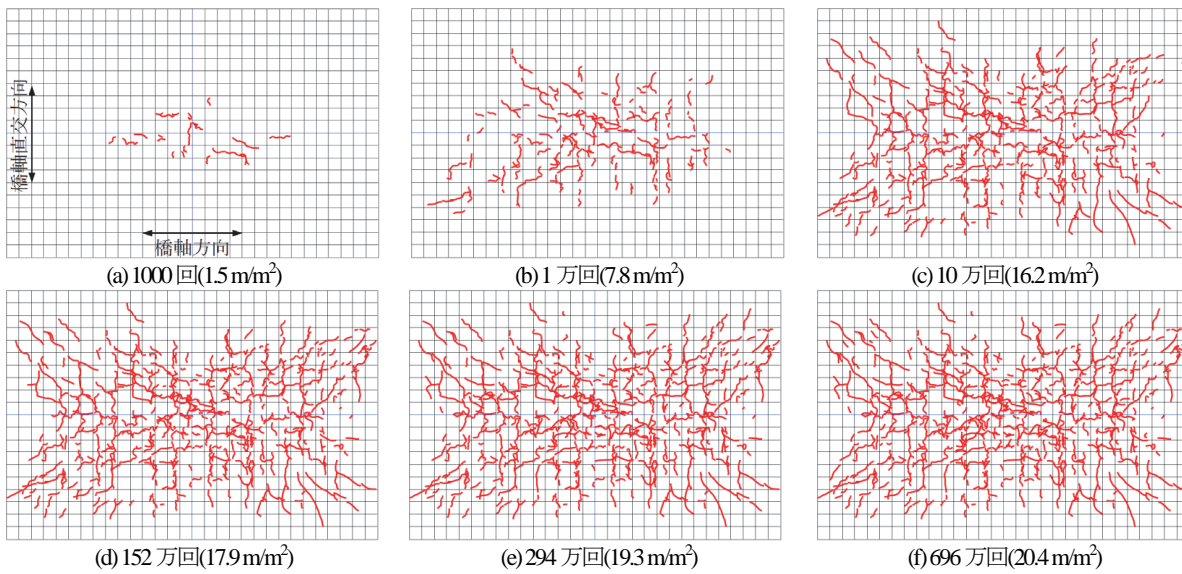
C供試体のひび割れ状況 ()内数値 ひび割れ密度m/m²
